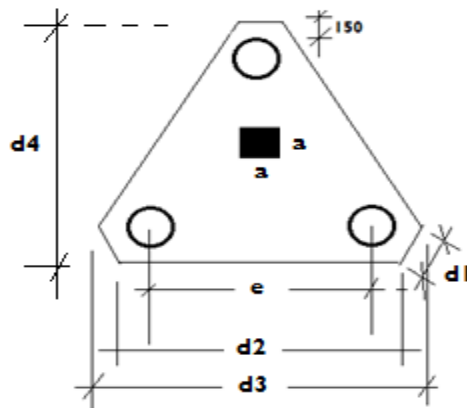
Vue en plan de la semelle sur 3 pieux
